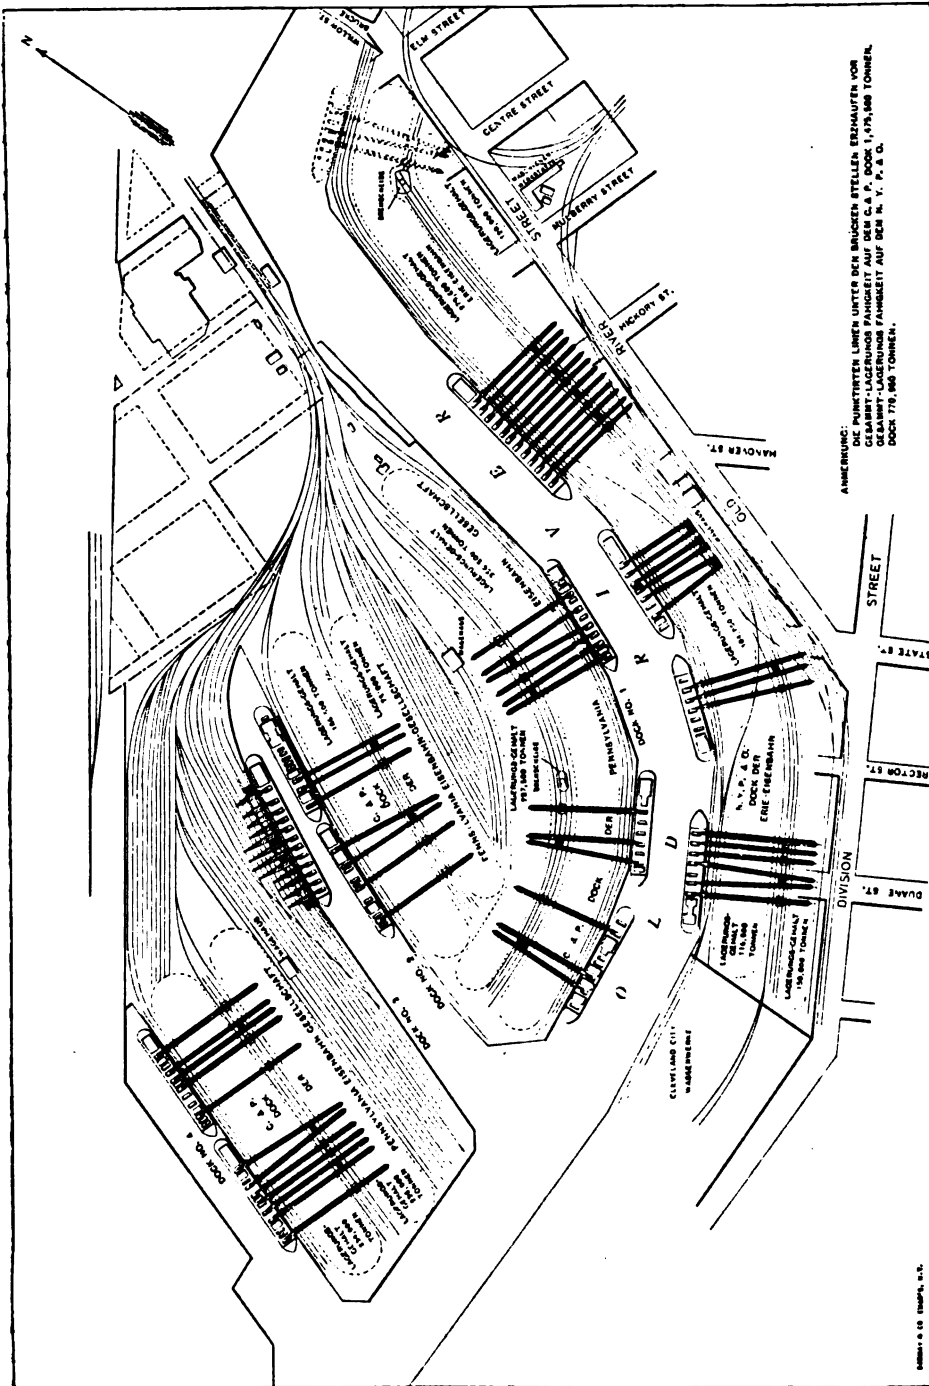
Plan der Erzdocks in Cleveland, Ohio. Anordnung der „Brownholts“.
